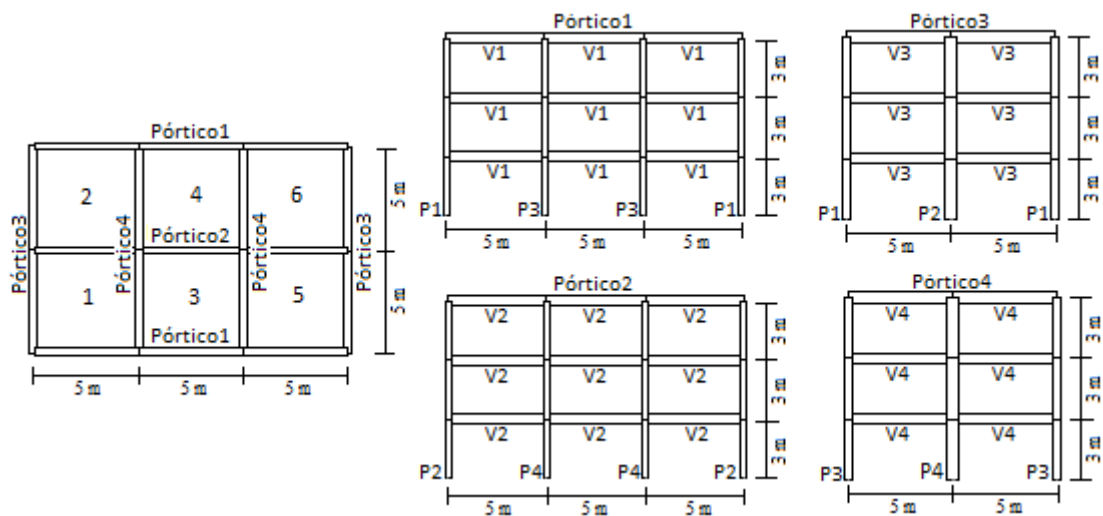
Planta e alçados do pórtico para as estruturas de betão armado
